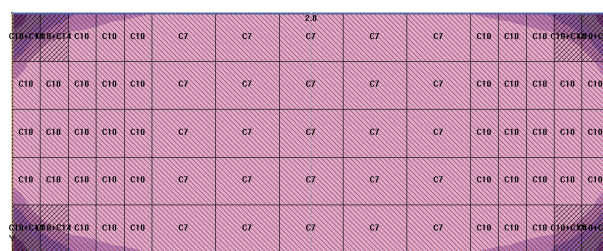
Схема раскладки арматурных сеток верхнего пояса
